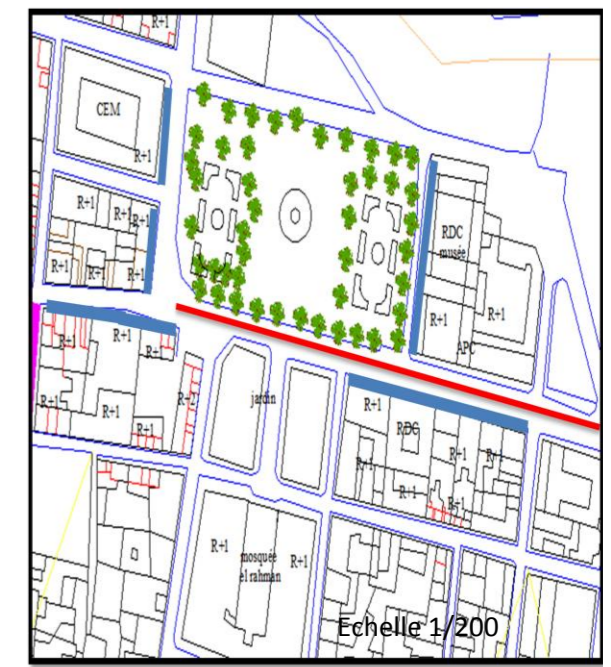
Le plan qui montre la forme et les parois de la place de
